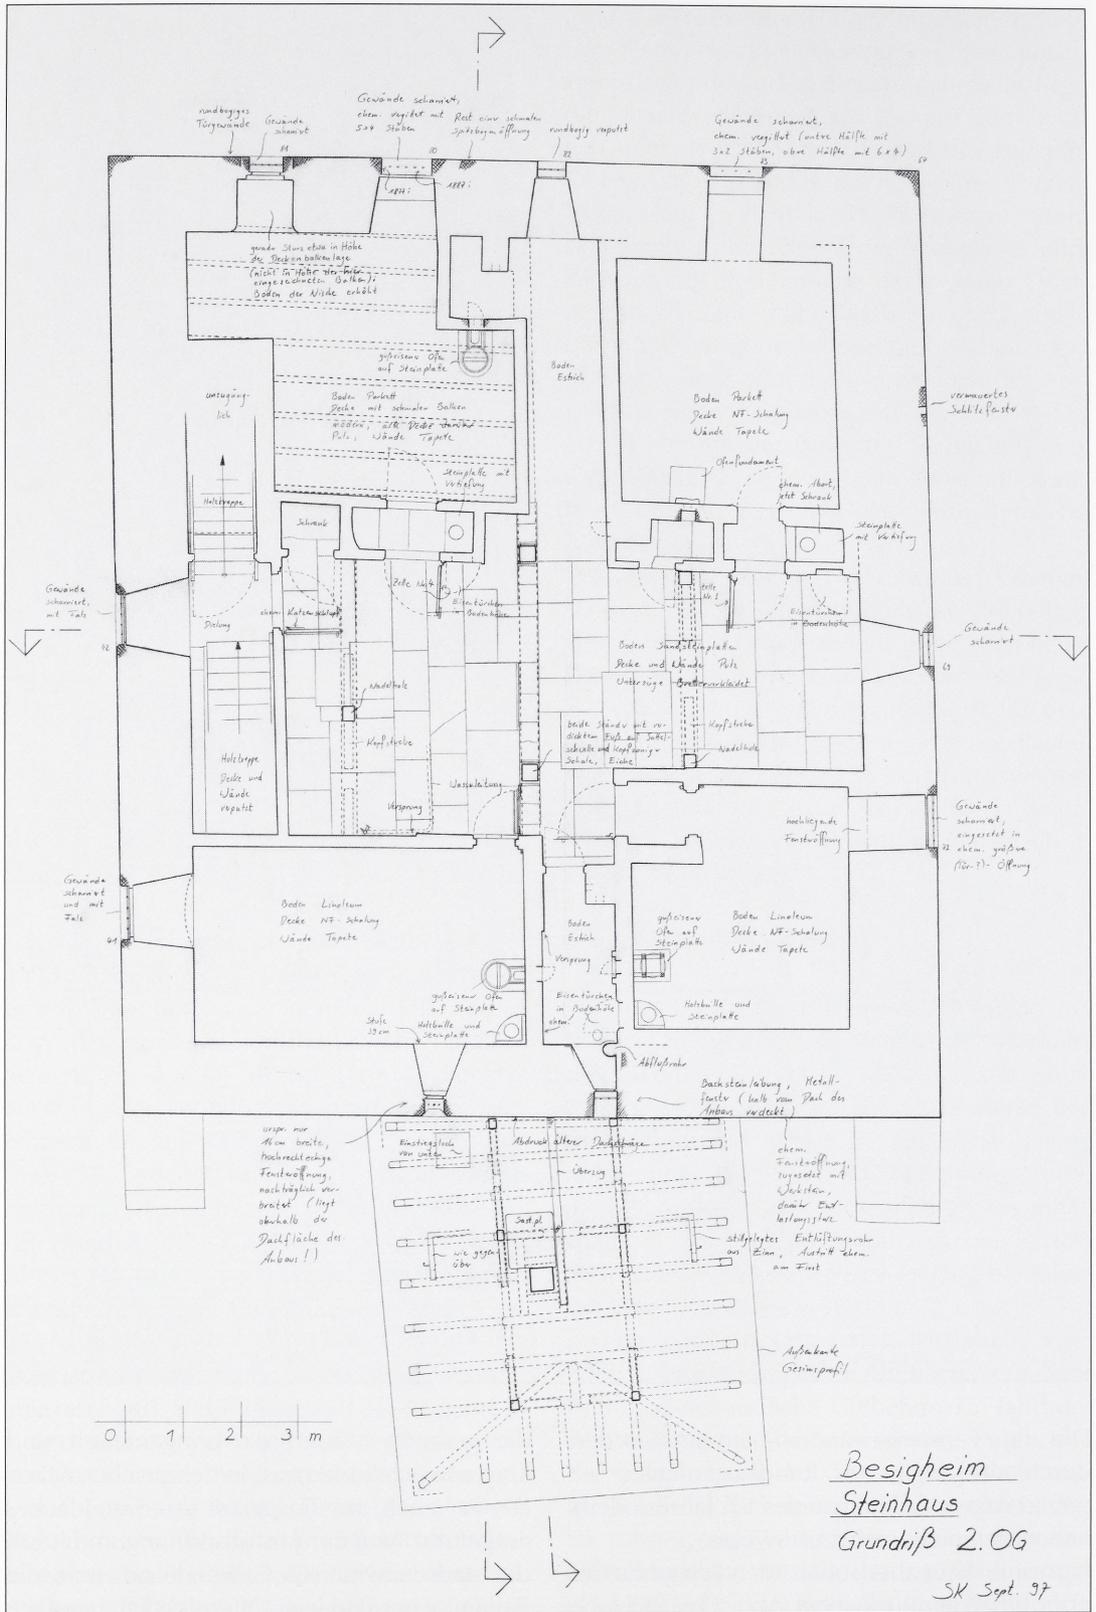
Besigheim, Steinhaus. Grundriss 2. Obergeschoss, Bestand 1997.
